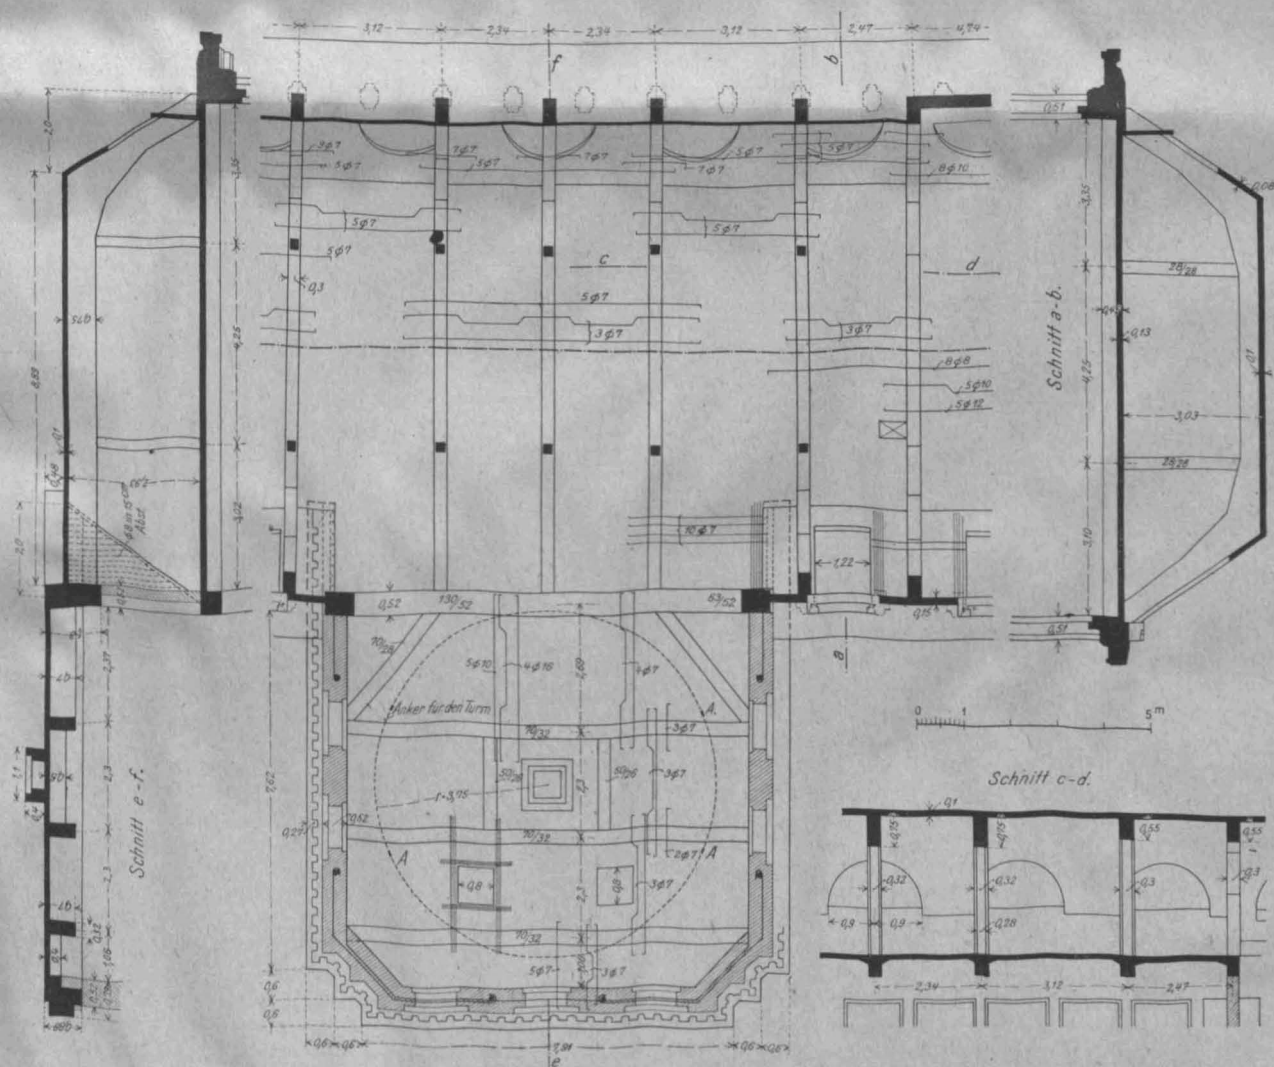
Decken-Grundrißteil des IV. Obergeschosses im Mittelbau mit Treppenturm.
